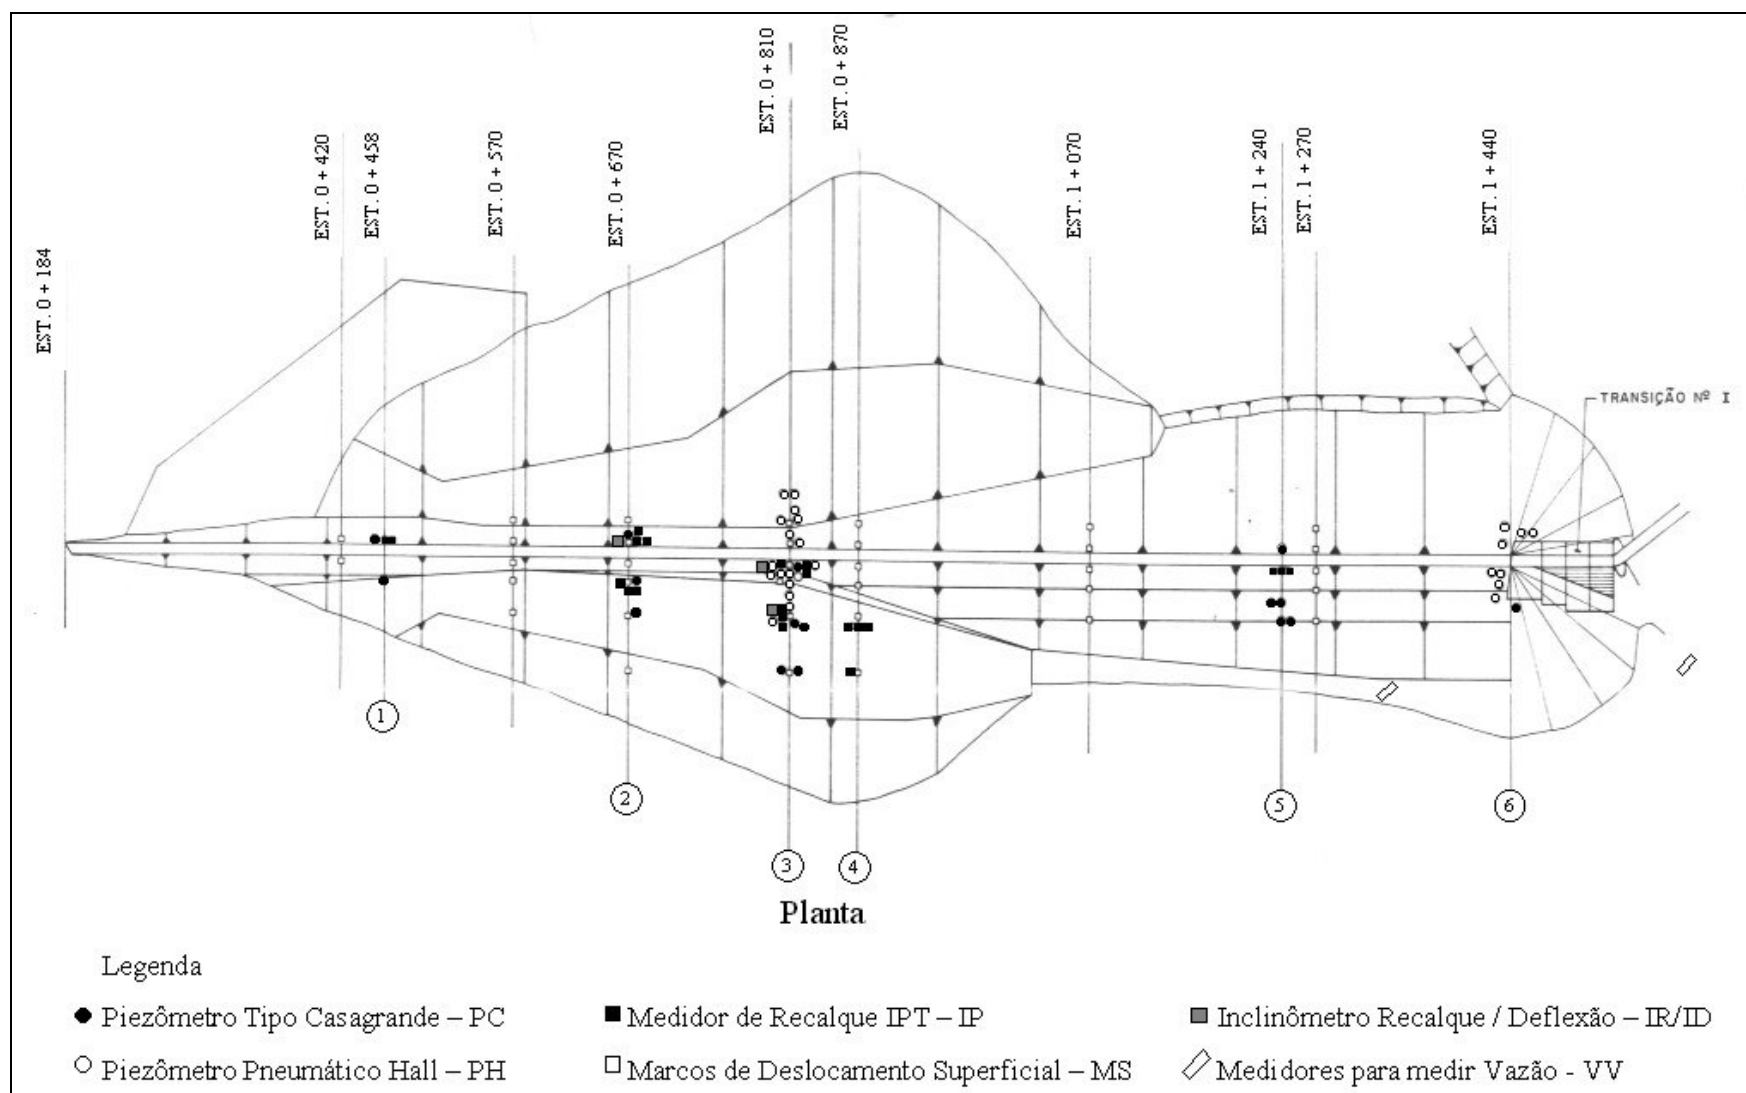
Planta da Instrumentação Instalada na Barragem de Terra da Margem Direita (BD) da UHE São Simão
